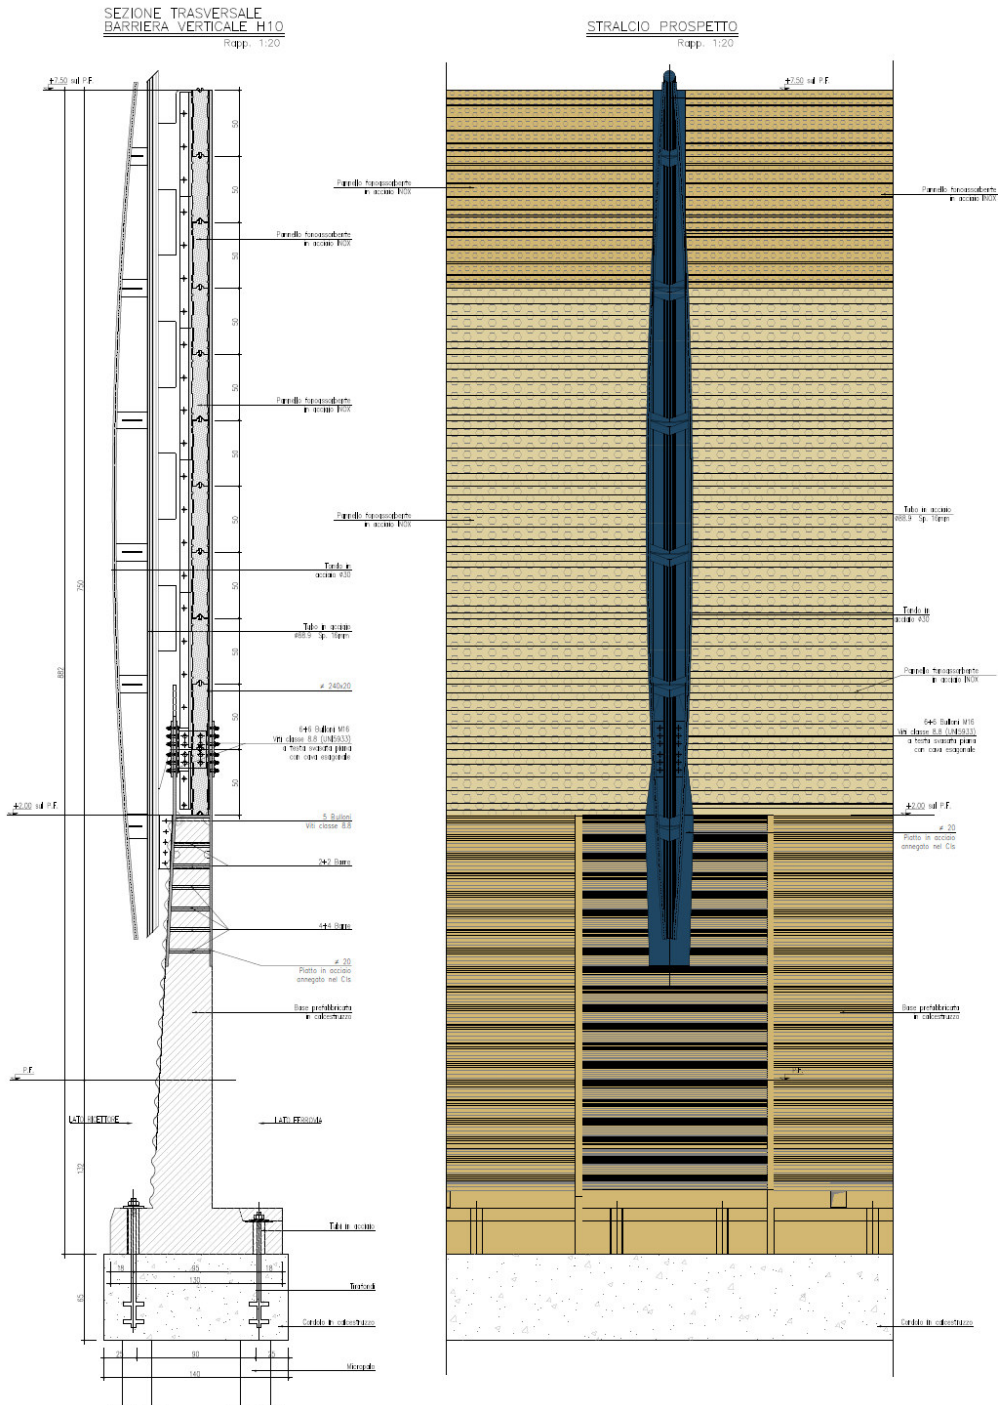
prospetto sezione dettagli – Barriera verticalizzata
